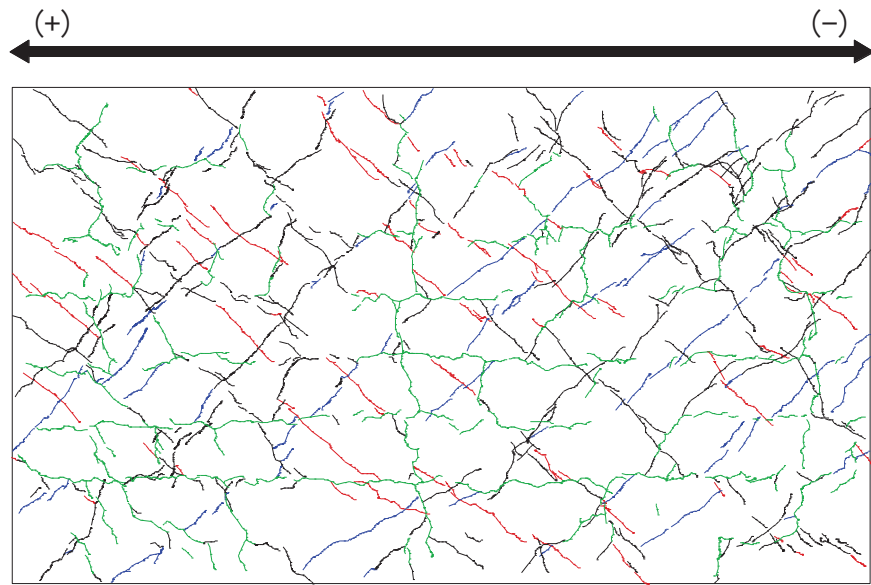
(9) 乾燥試験体 [2] 1/500rad. におけるひび割れ図
